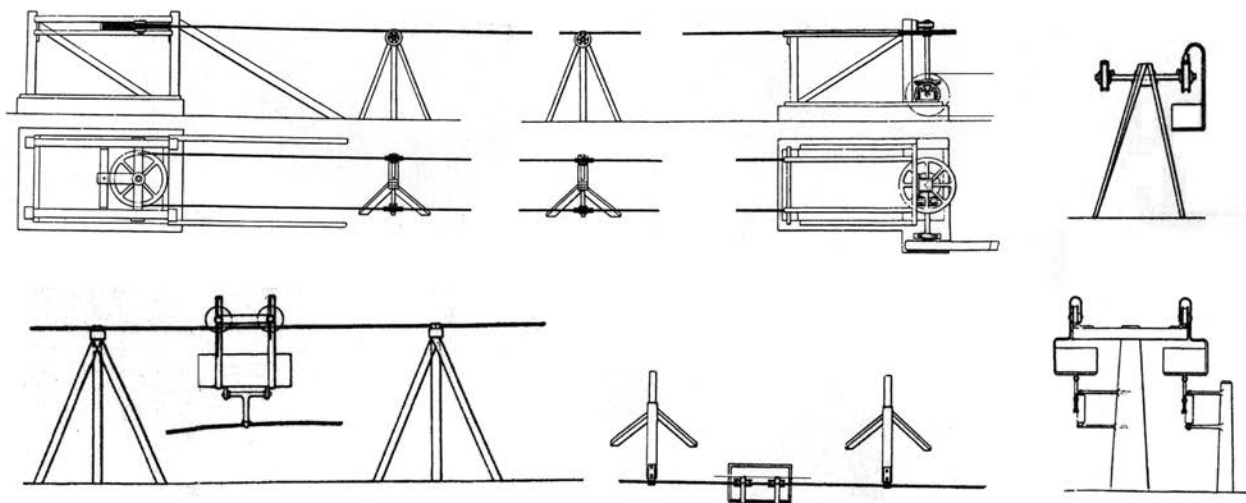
Sistemas patentados por Hodgson, en planta y alzado. Arriba, monocable; abajo, bicable, ambos con sus respectivas torres (Dieterich, 1908, 52, modificada).
